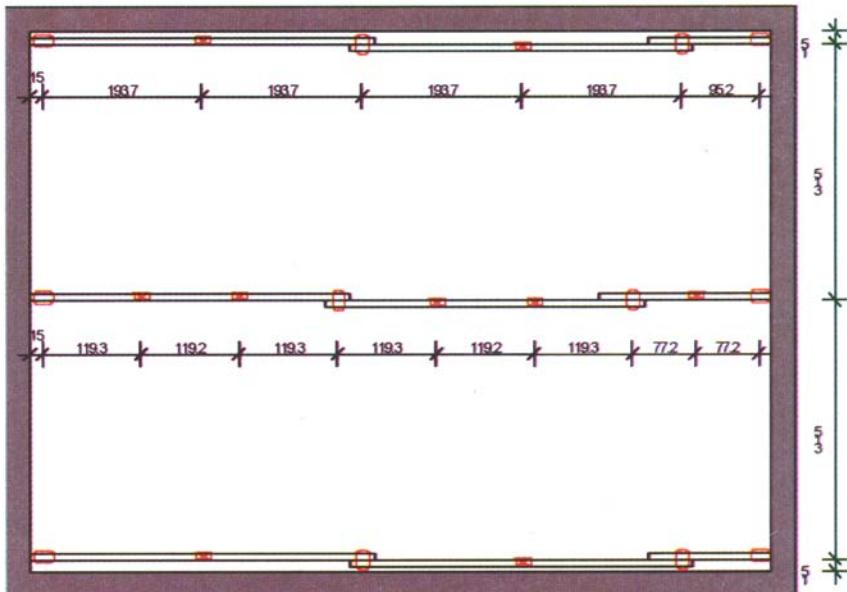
Раскладка продольных балок параллельно длинной стороне помещения
